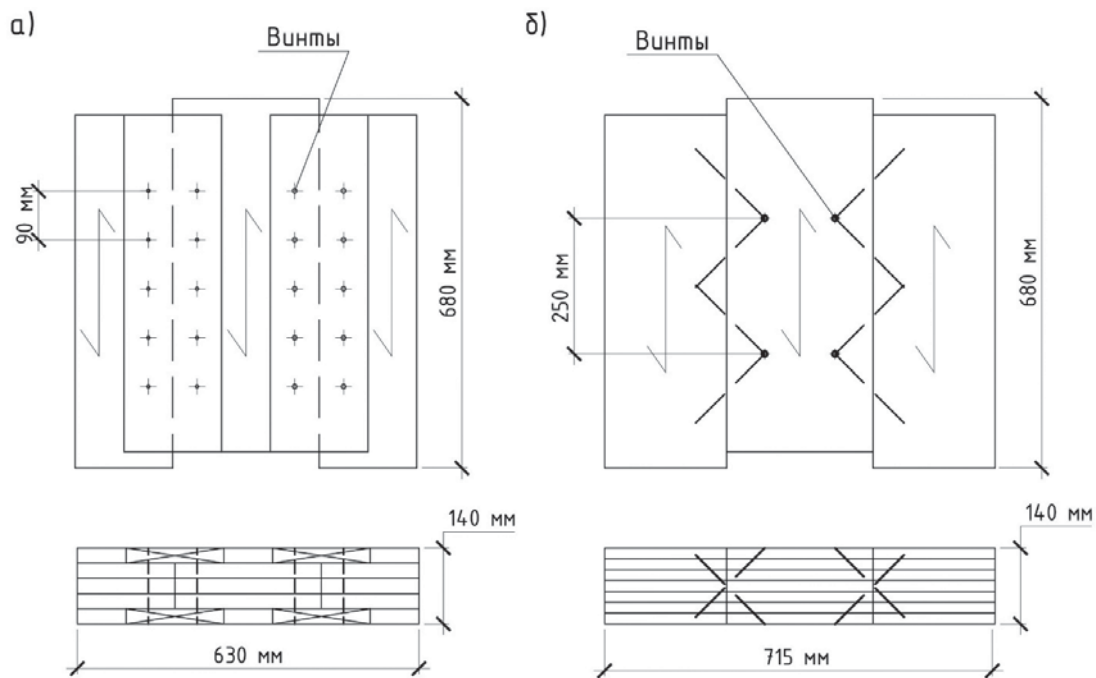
Конструкция образцов соединений типов «с накладкой» (а) и «встык» (б)
